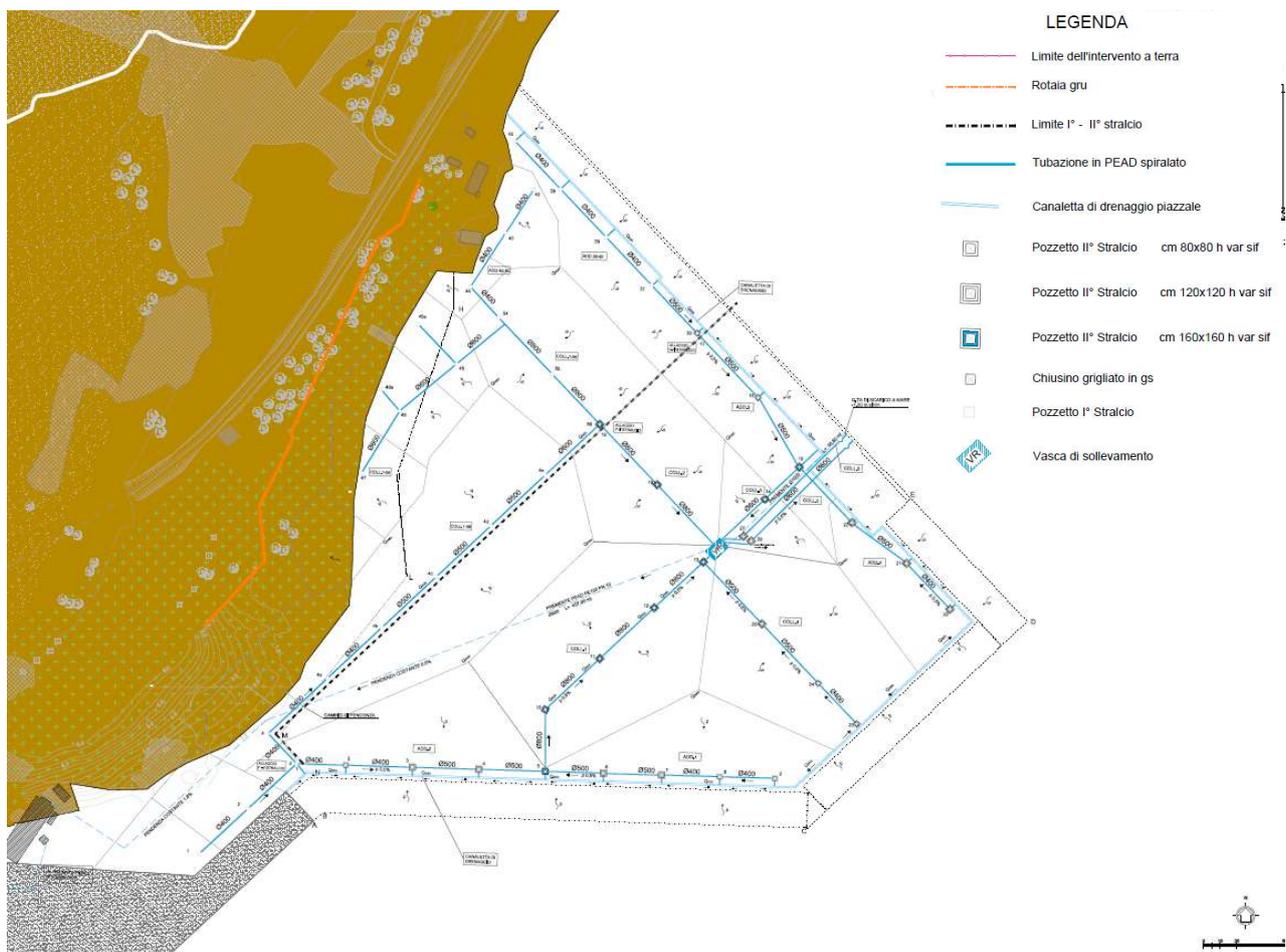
Planimetria rete idrica acque bianche - Progetto Esecutivo
